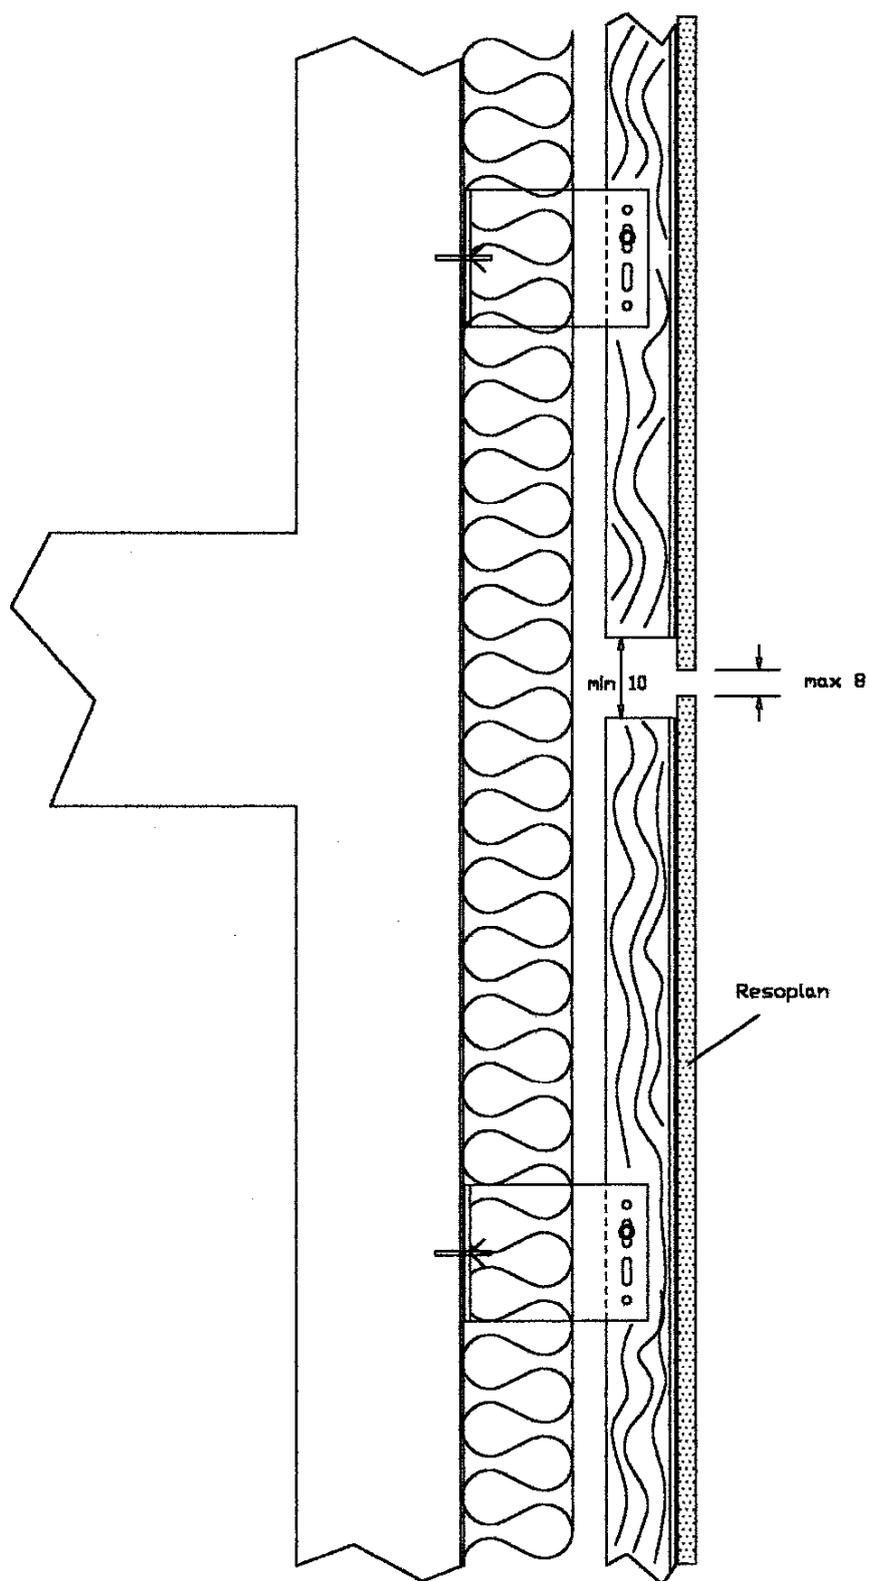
Coupe verticale sur joint de fractionnement au droit de chaque plancher
